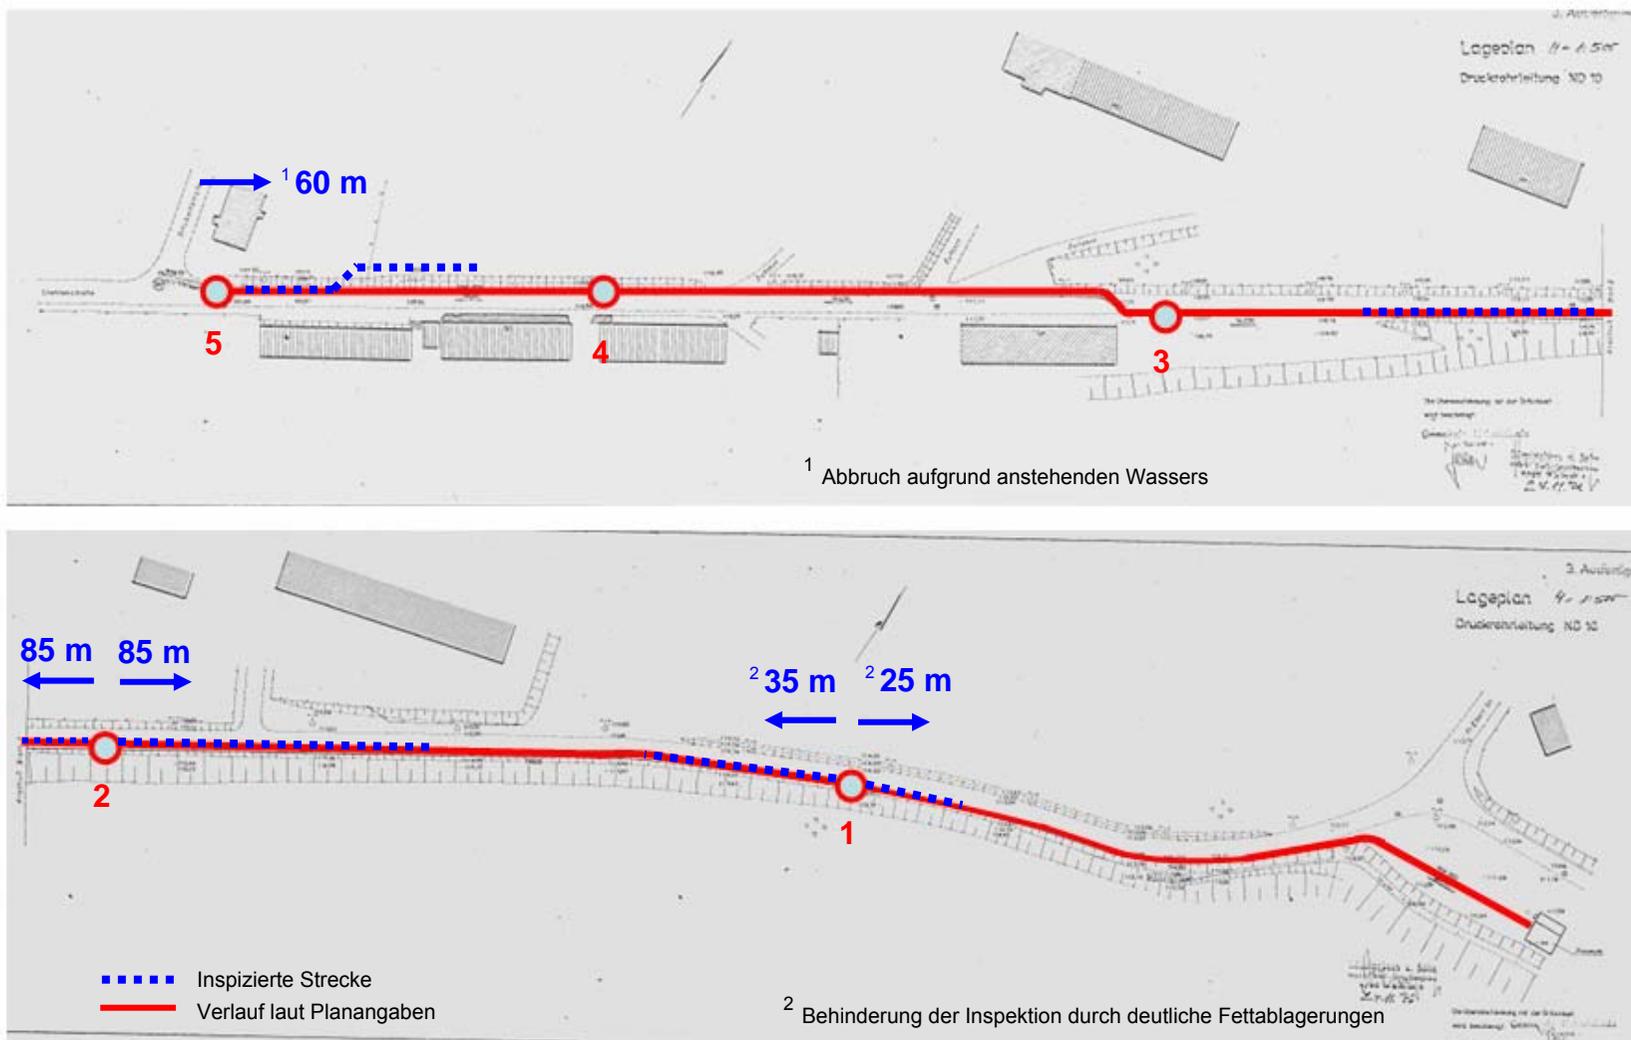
Lageplan Druckleitung Guss DN 300, Länge rund 800 m, Holzwickede
